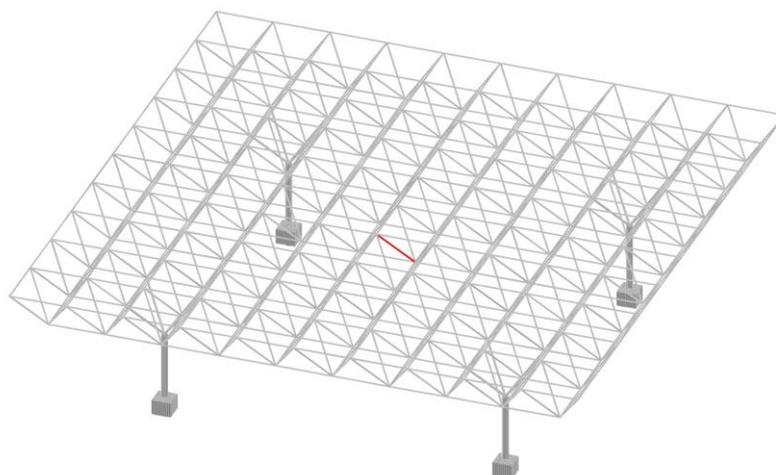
Расчетная схема с одним вышедшим из строя элементом
